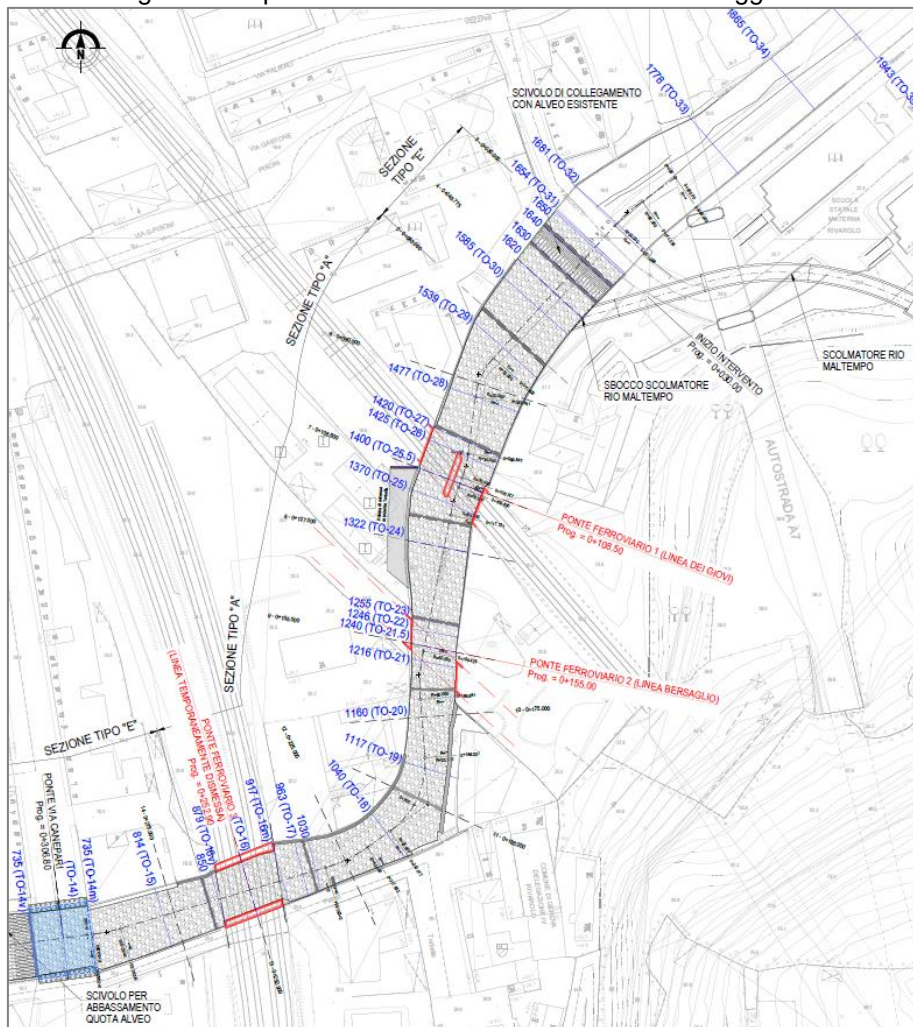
Planimetria dell'intervento con la rappresentazione delle sezioni per la modellazione idraulica (tratto di monte, II151F-PD-IDR-D001_0)
